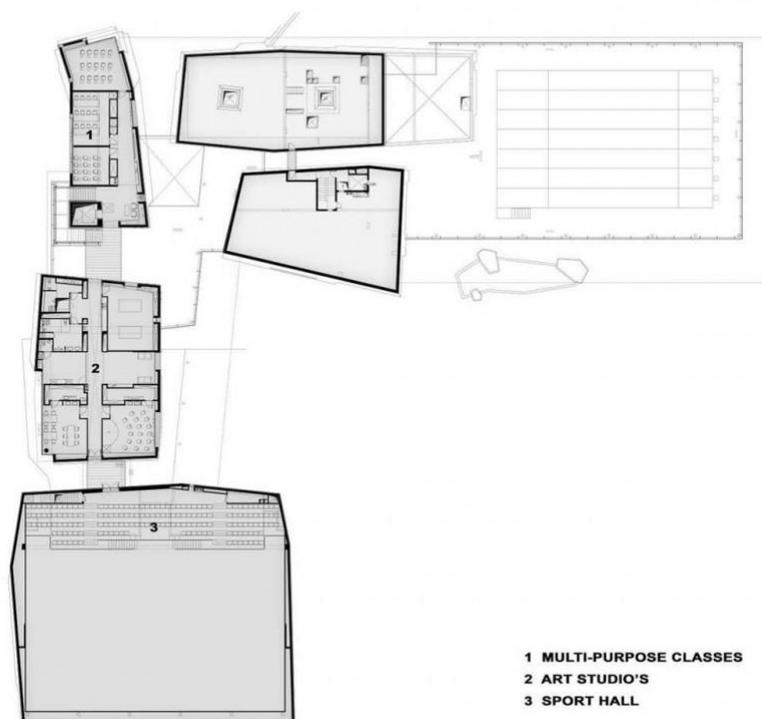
PLANTA PRIMEIRO PAVIMENTO
